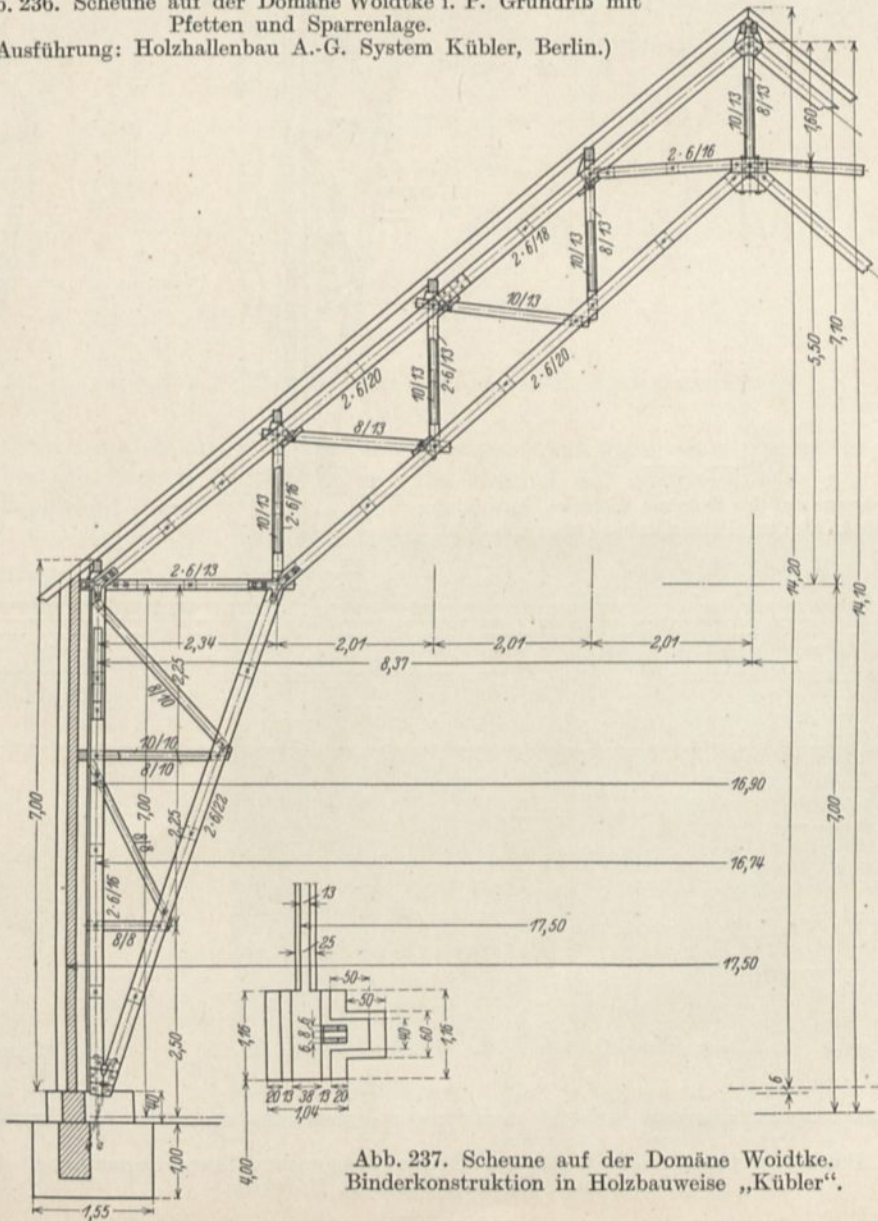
Scheune auf der Domäne Woidtke. Binderkonstruktion in Holzbauweise „Kübler“.
